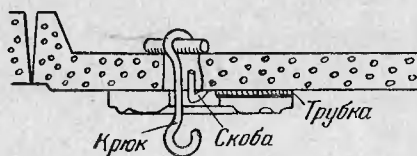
Установка крюка для подвески осветительной арматуры на железобетонной плите перекрытия.
